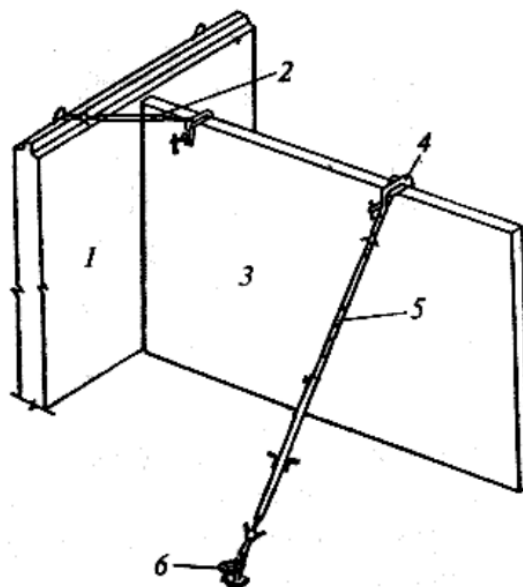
Схема тимчасового кріплення панелі внутрішньої стіни за допомогою монтажного зв'язку та підкосу з інвентарною петлею:
